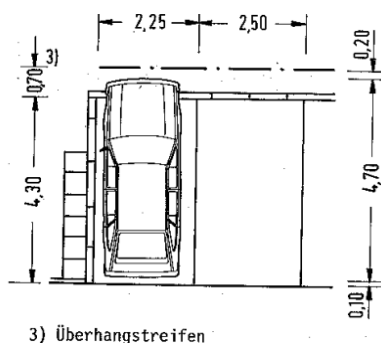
Základní šířka parkovacího stání s bočním omezením [13]
